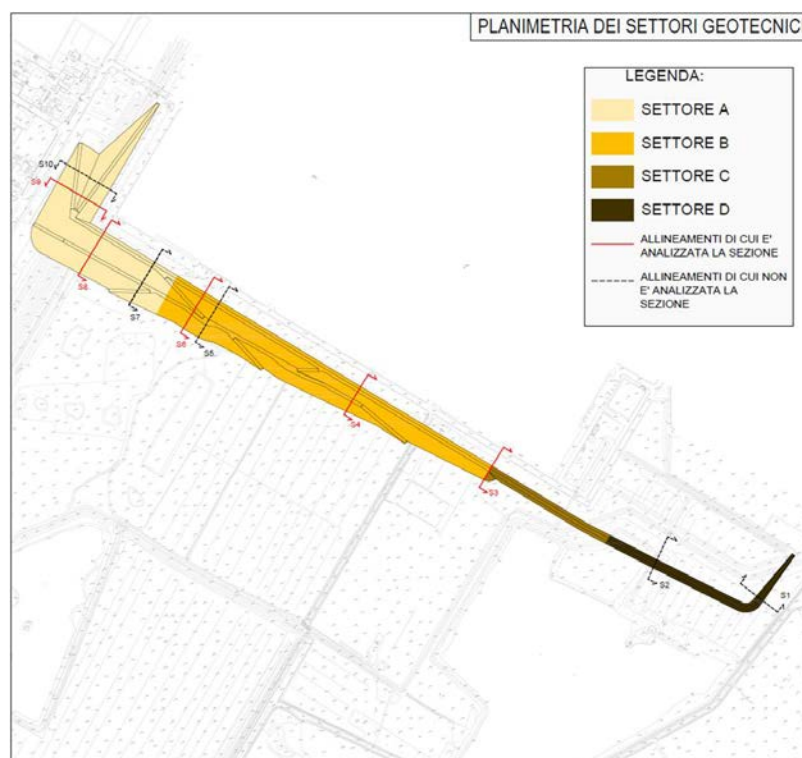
Schema planimetrico con indicazione delle differenti tipologia di sezione.
